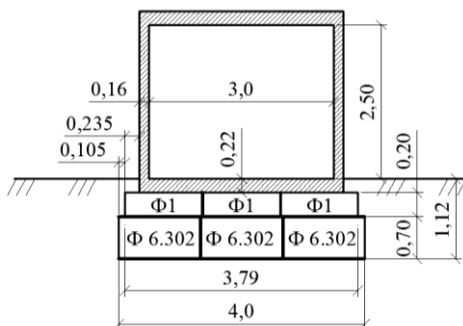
Схема компоновки фундаментных плит и блоков водопрпускной трубы:
